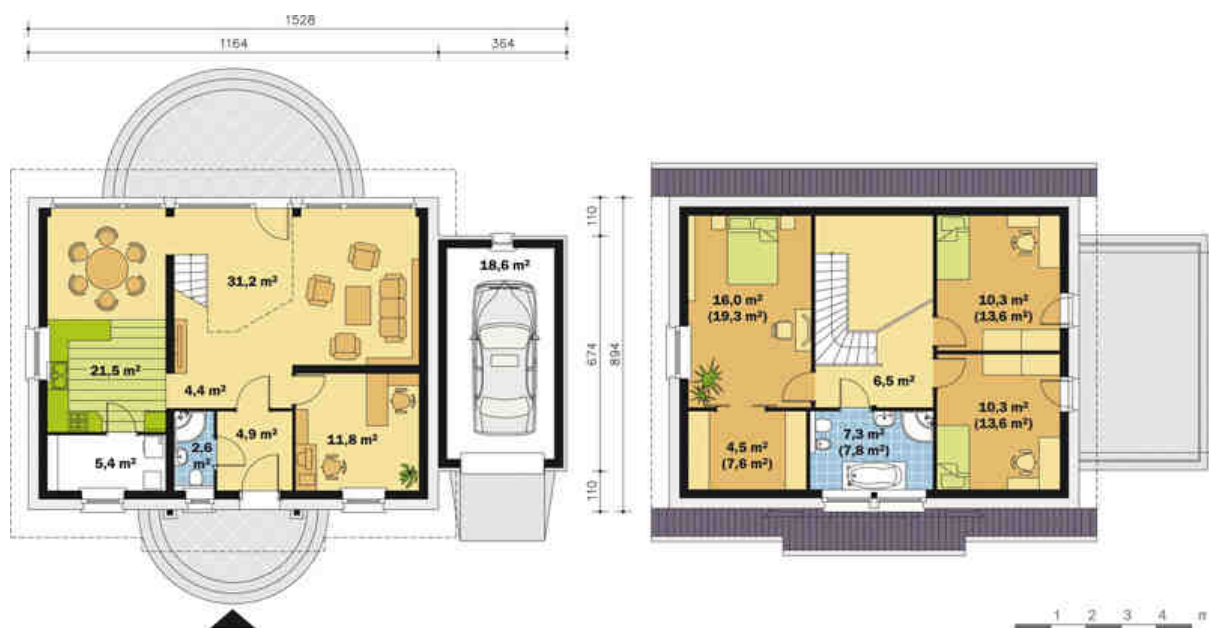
Grundriss von Erdgeschoss und Dachgeschoss
